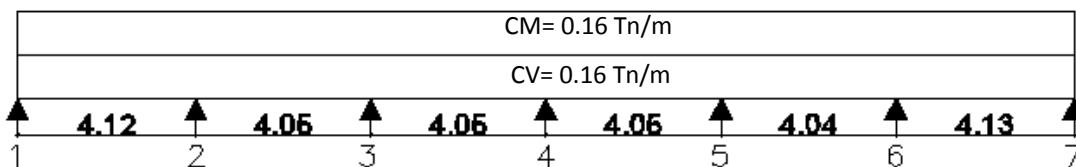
Cargas en viguetas de pasadizo en 1° piso modulo “A”
